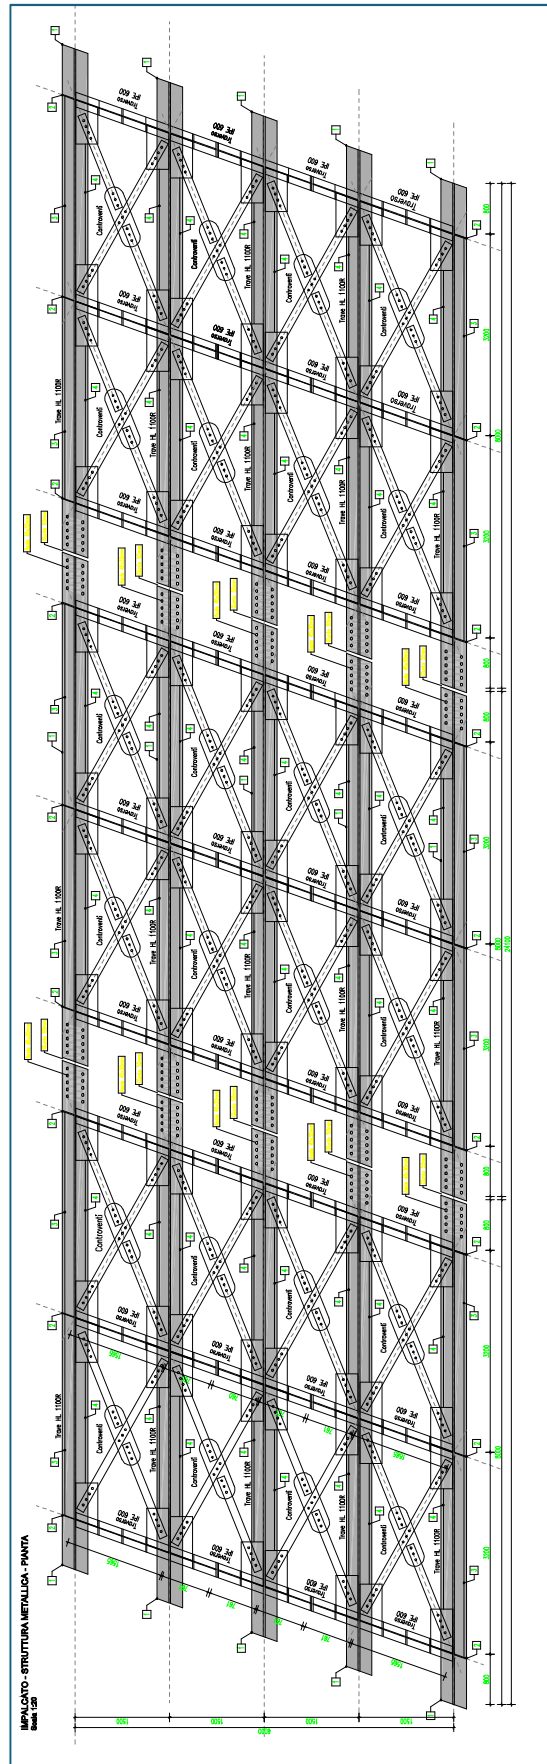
Pianta del ponte con indicazione della struttura di acciaio.
